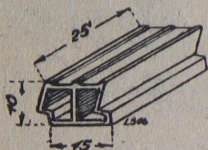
Потолочный кирпич Forster с боковыми выступами
